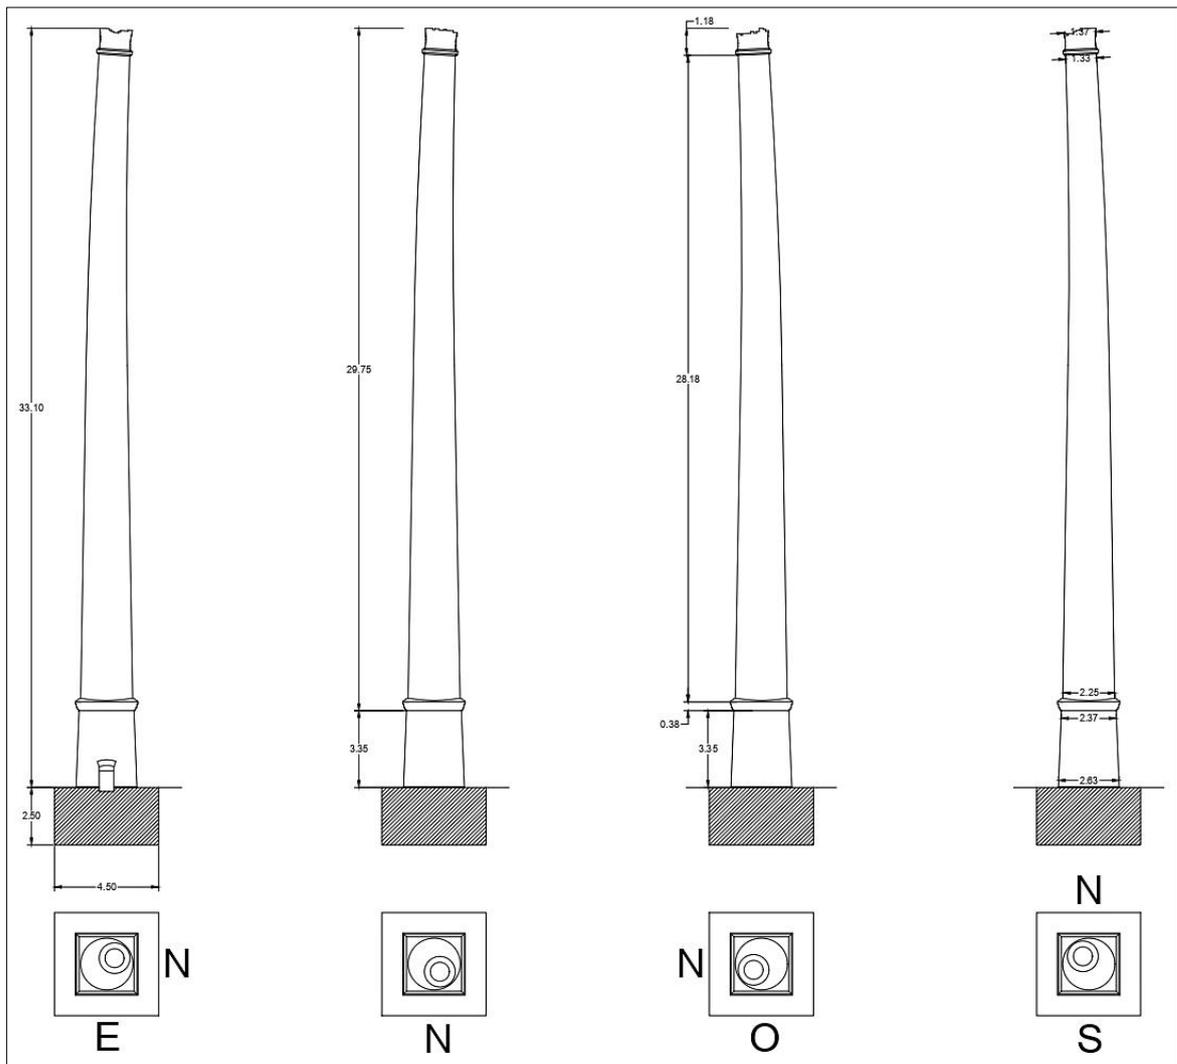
Alzados y plantas de la chimenea Santa Faz de Aspe.
